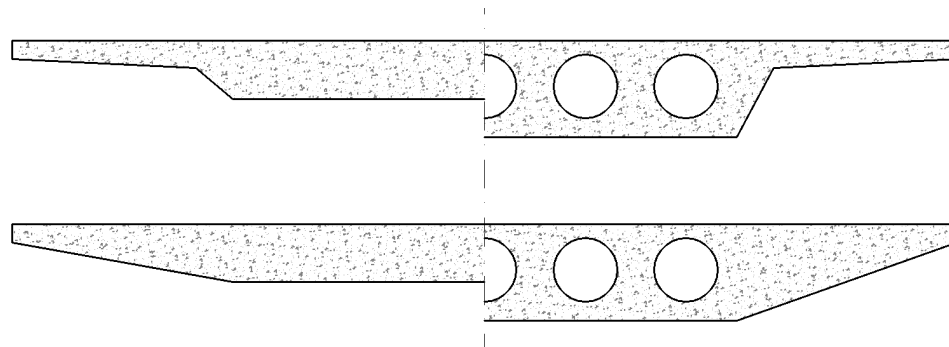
Secciones Transversales Típicas de Vigas Prefabricadas
